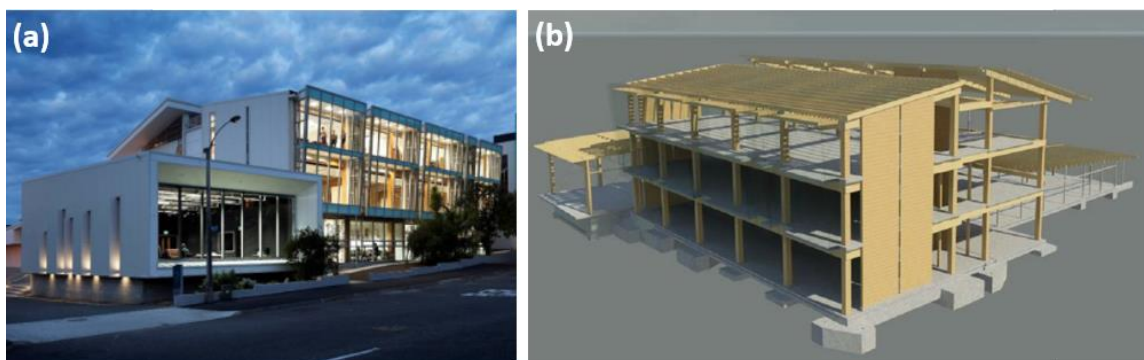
Edificio NMIT Arts and Media: (a) Fachada del edificio y (b) Vista en 3D del sistema estructural [67].
